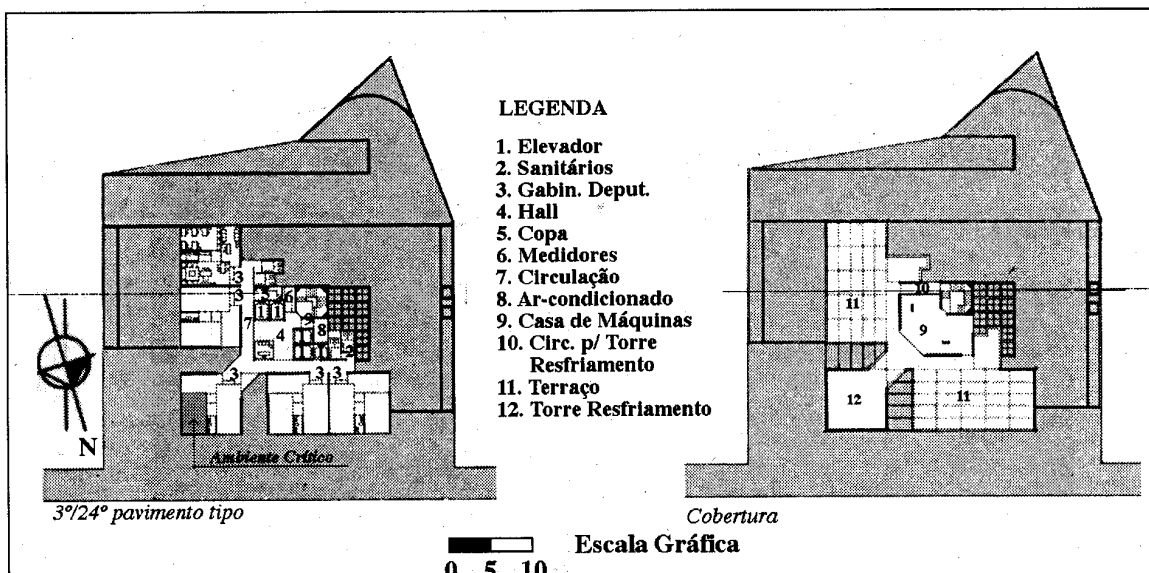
Planta Pavimento Tipo com ambiente crítico indicado, e planta de Cobertura. Fonte: 13
